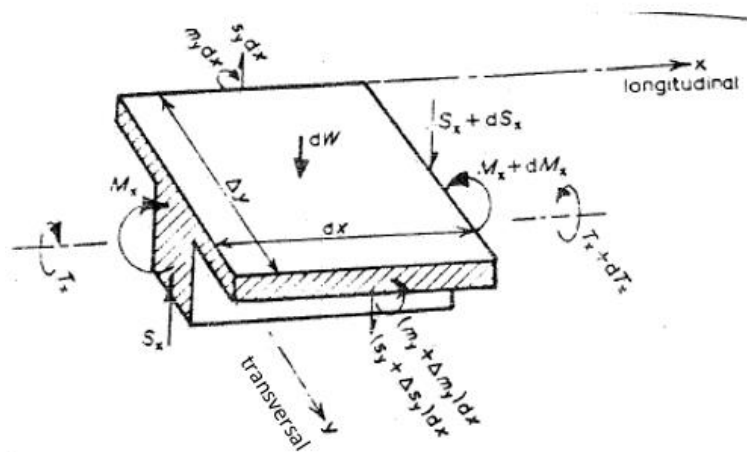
Elemento de tabuleiro em laje e vigas. Fonte: Adaptado de Hambly (1991)
